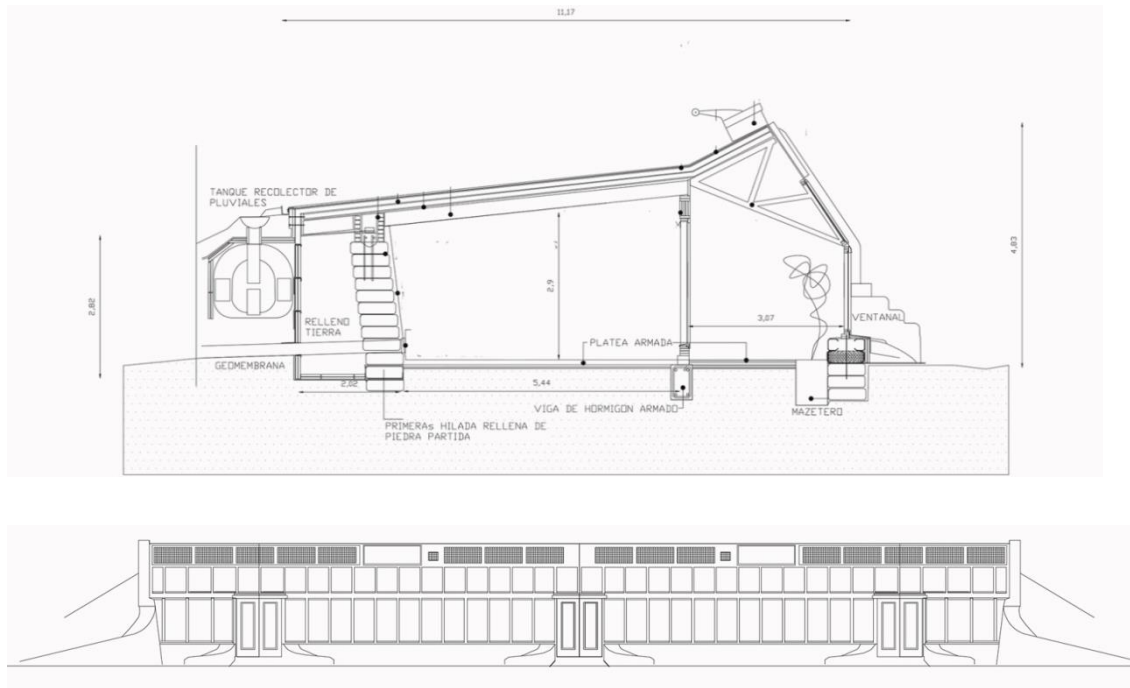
Plano de Corte y Elevación, Escuela Sustentable N° 294 Jaurequiberry.
